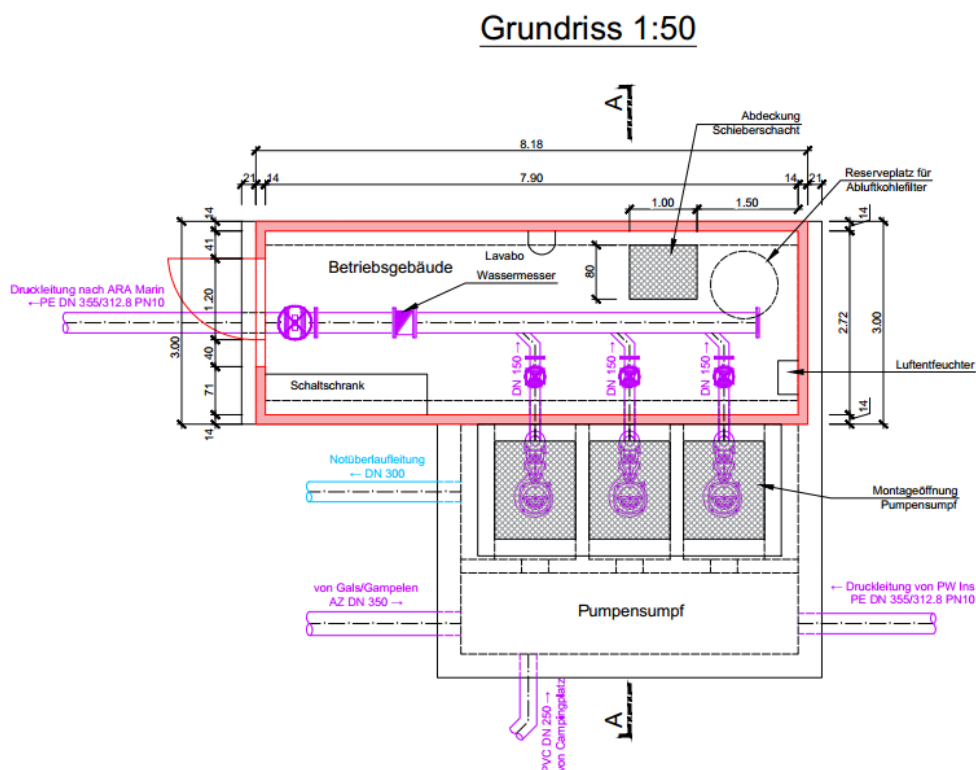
Vue en plan, rez-de-chaussée, de la nouvelle station de pompage Rothaus
